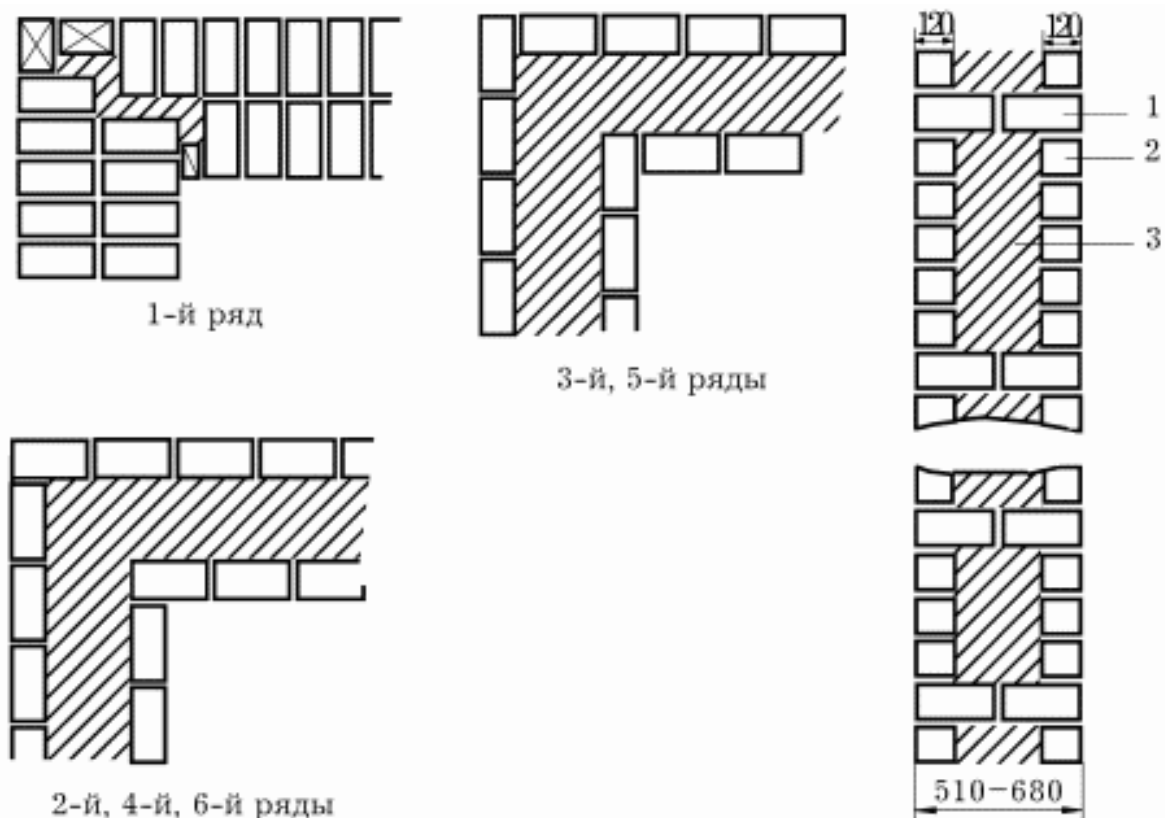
Облегченная кирпично-бетонная кладка(размеры даны в мм): 1 – тычковые ряды; 2 – ложковые ряды; 3 – легкий бетон.
